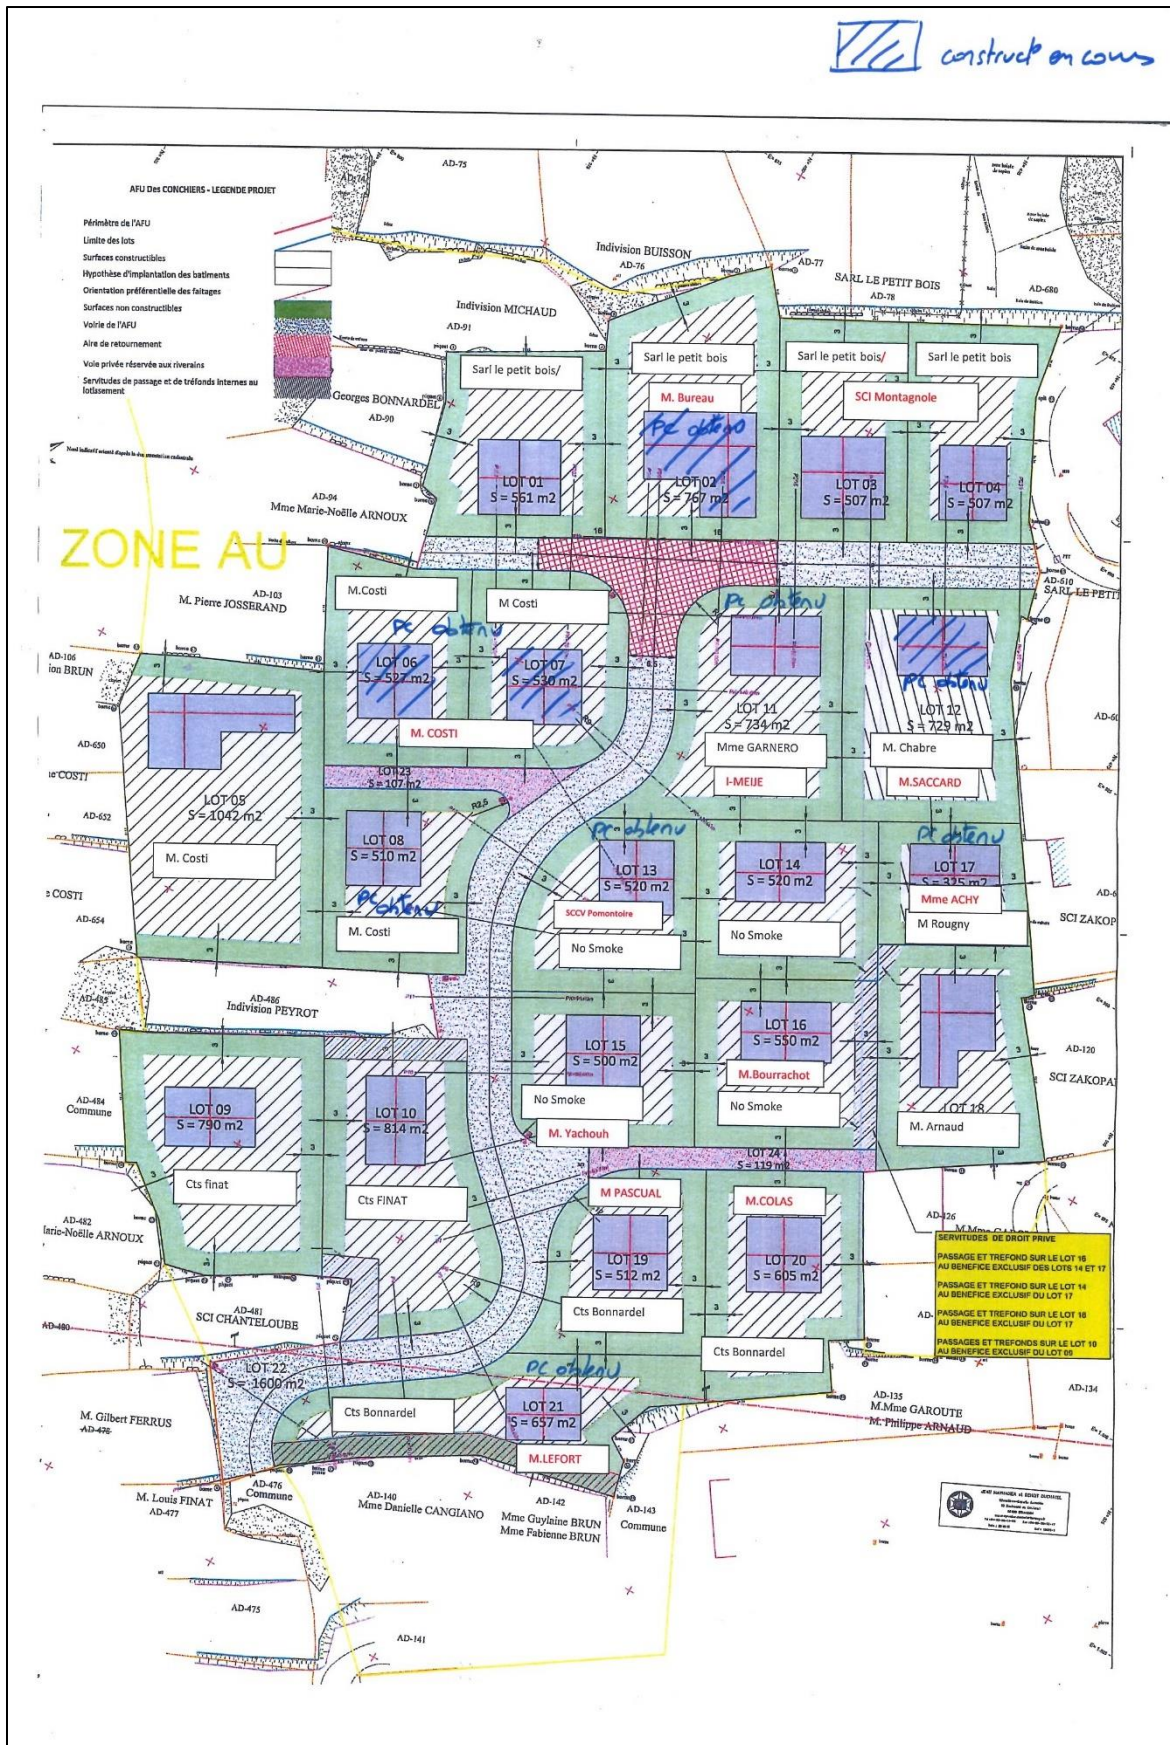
Plan extrait du permis d'aménager accordé sur le secteur des Conchiers
